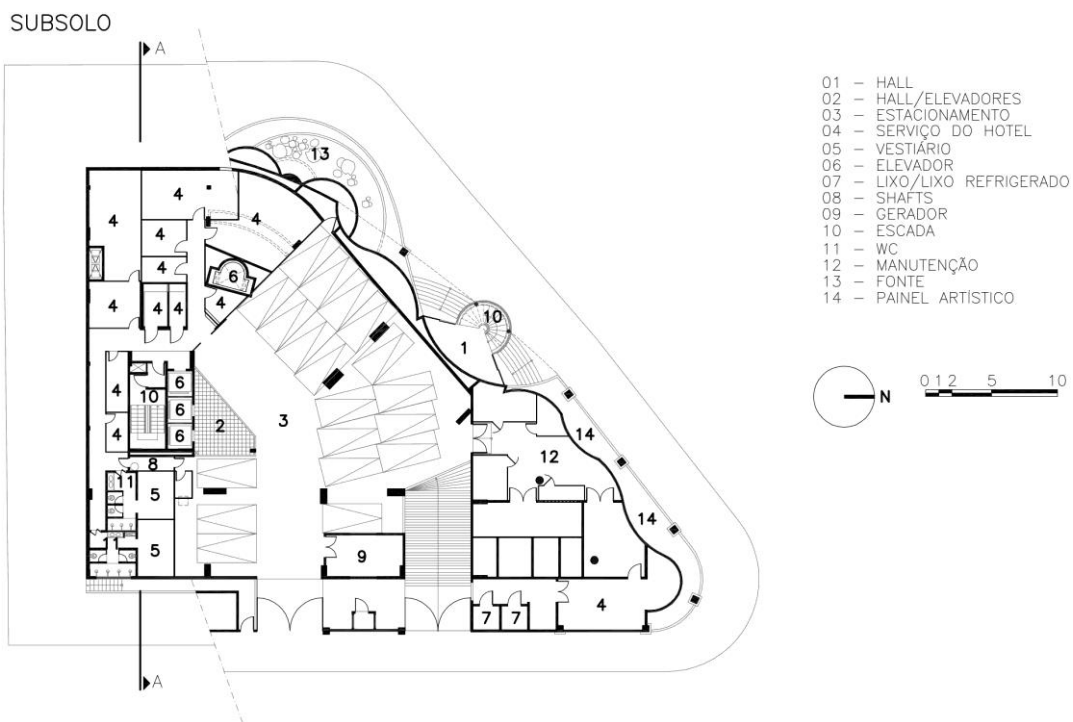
Othon Palace Fortaleza: pavimento subsolo
